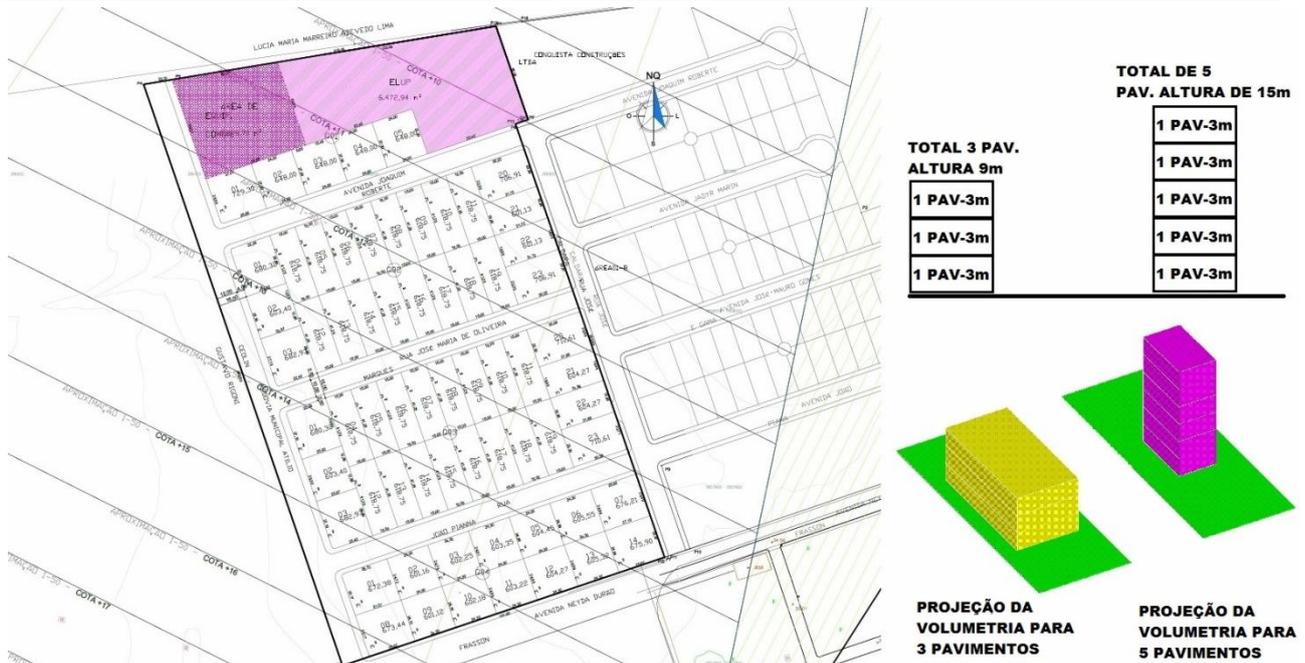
A- Planta do loteamento com as cotas de restrição de verticalização/cone vôo. Fonte: autor, outubro/2018.
